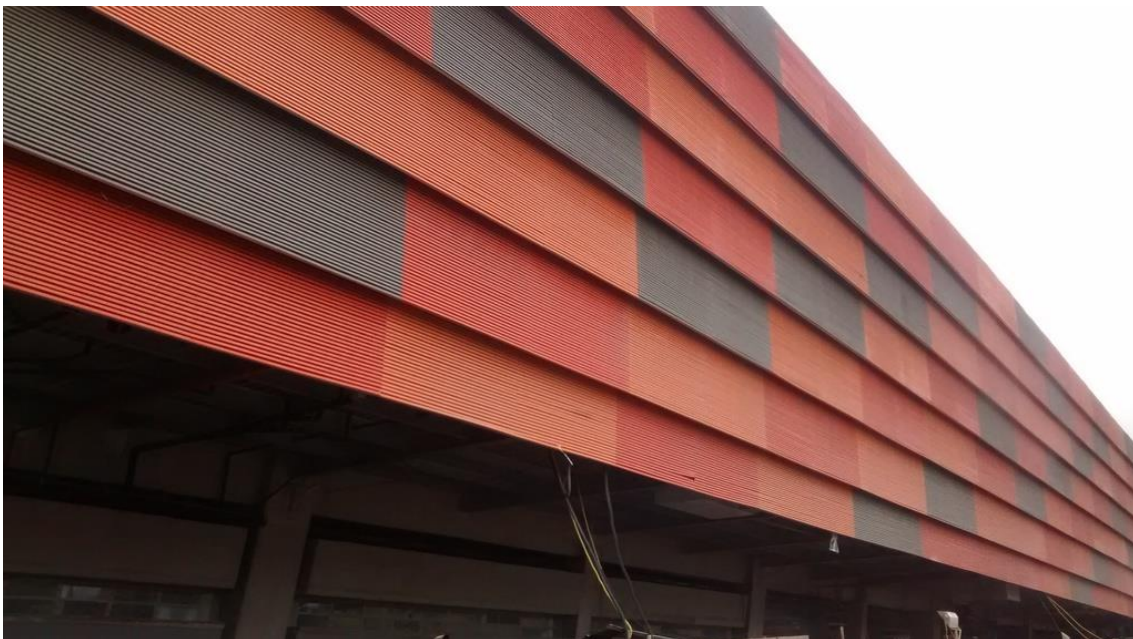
Foto dos brises da Estação Detran em construção (Fonte: Skyscrapercity)
